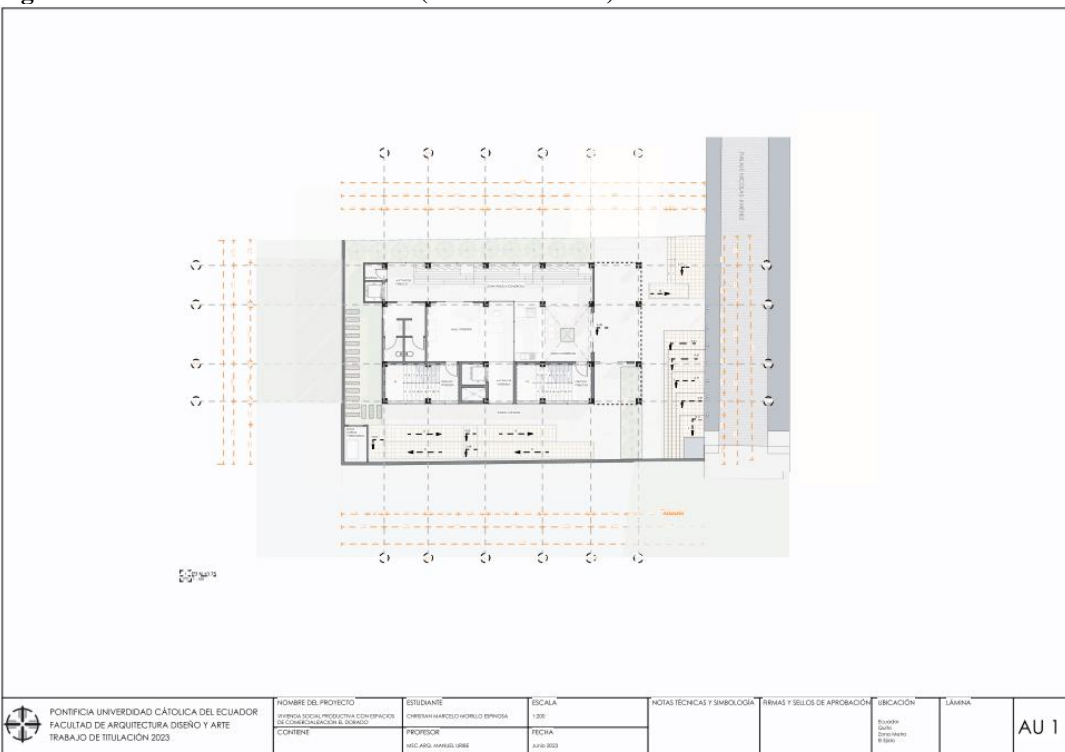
Primera intervención- Planta Baja- P3. (Morillo C. 2023)
